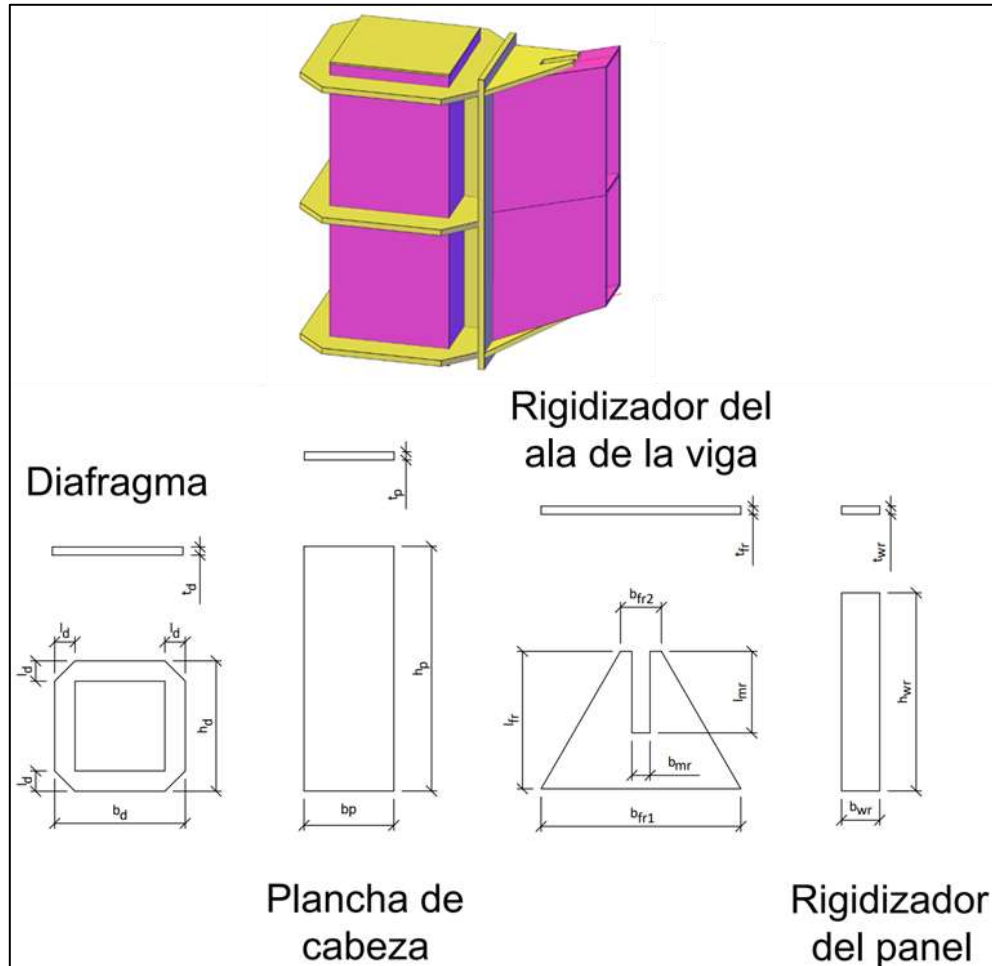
Conexión a momento Viga – Columna (Perfiles: tubulares)
